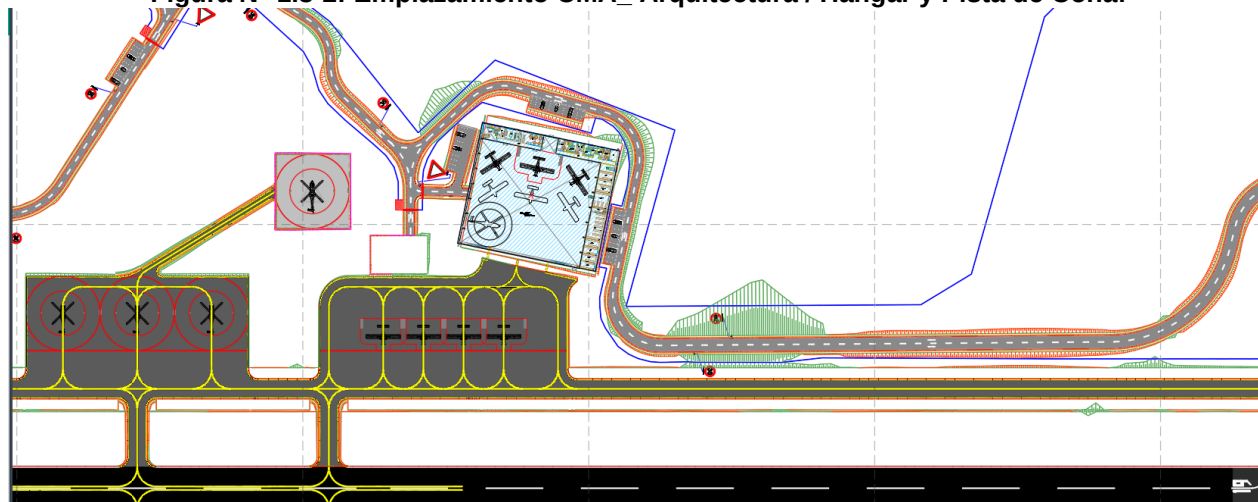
Propuesta Emplazamiento Hangar y CONAF
